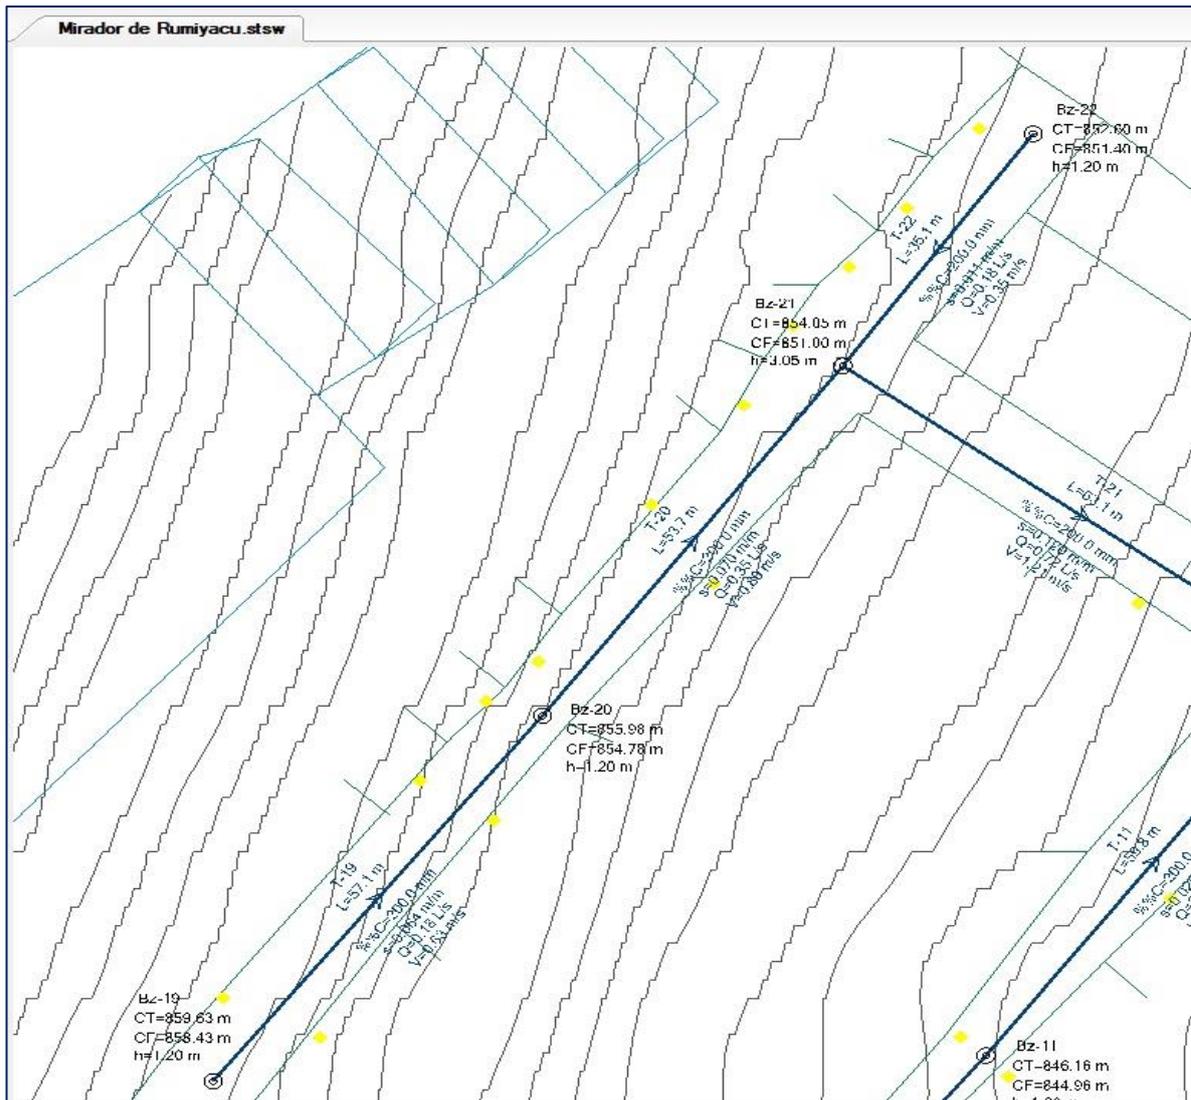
Vista de planta del buzón 19 al 21 y 22 al 21. (Fuente: Software SEWERCAD)
